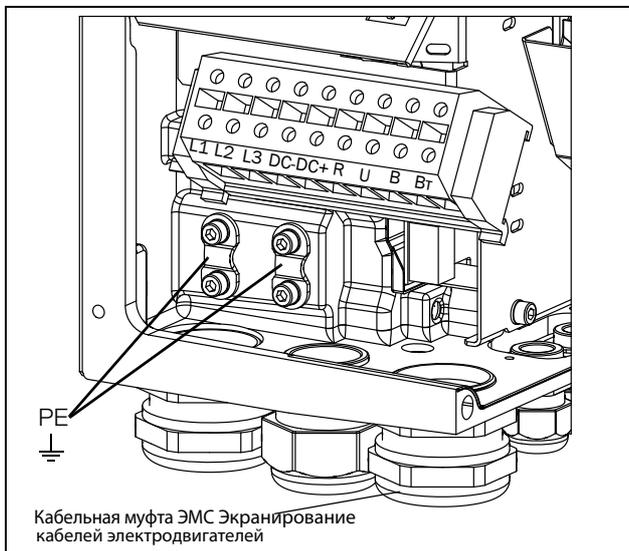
Подключение сетевого питания и двигателя модели 026-046, размер корпуса С.
